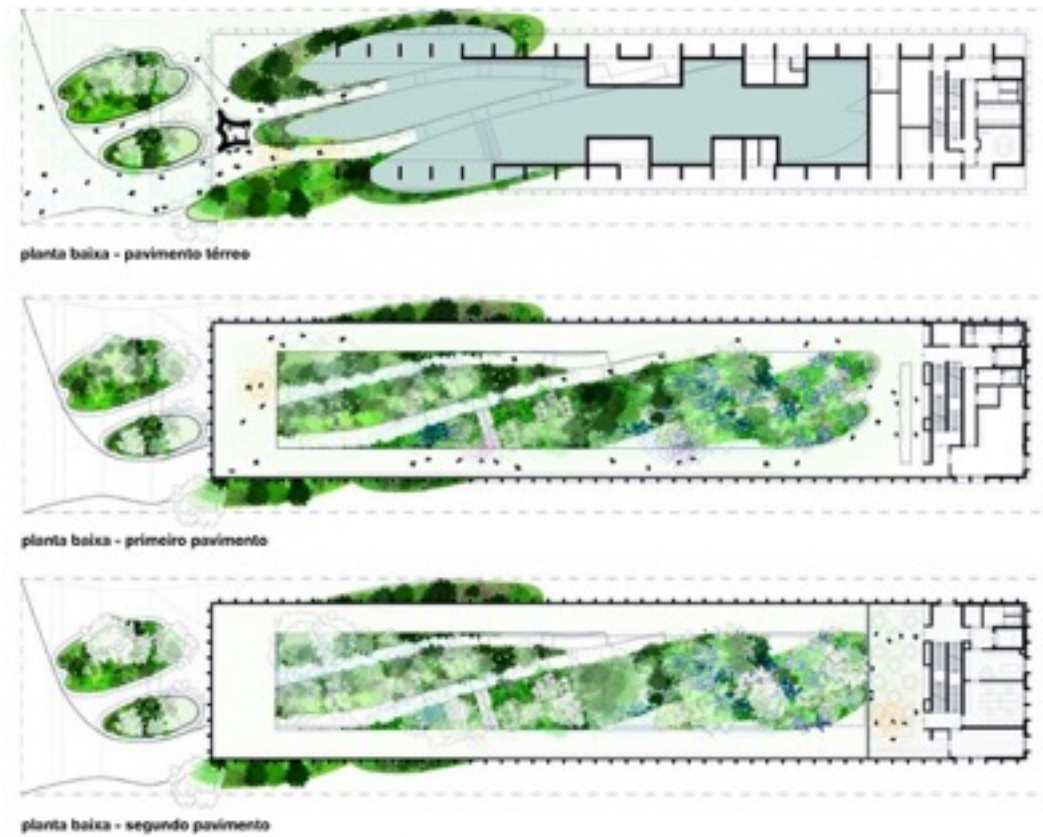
Plantas baixas do pavilhão - no térreo localiza-se o acesso principal e a área técnica do pavilhão. No segundo e terceiro pavimento, completa-se o percurso.
